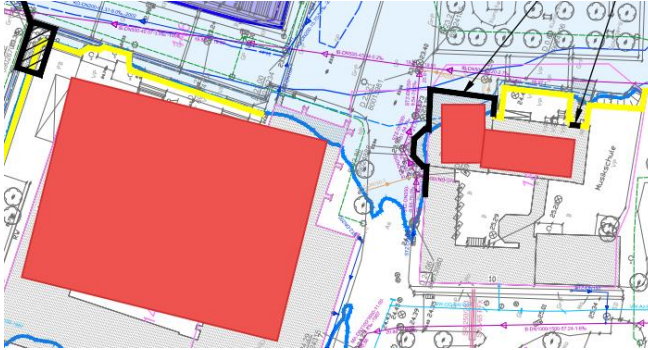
Lageplan Gebäude Teil 1 (südlich Stadtbrücke)
